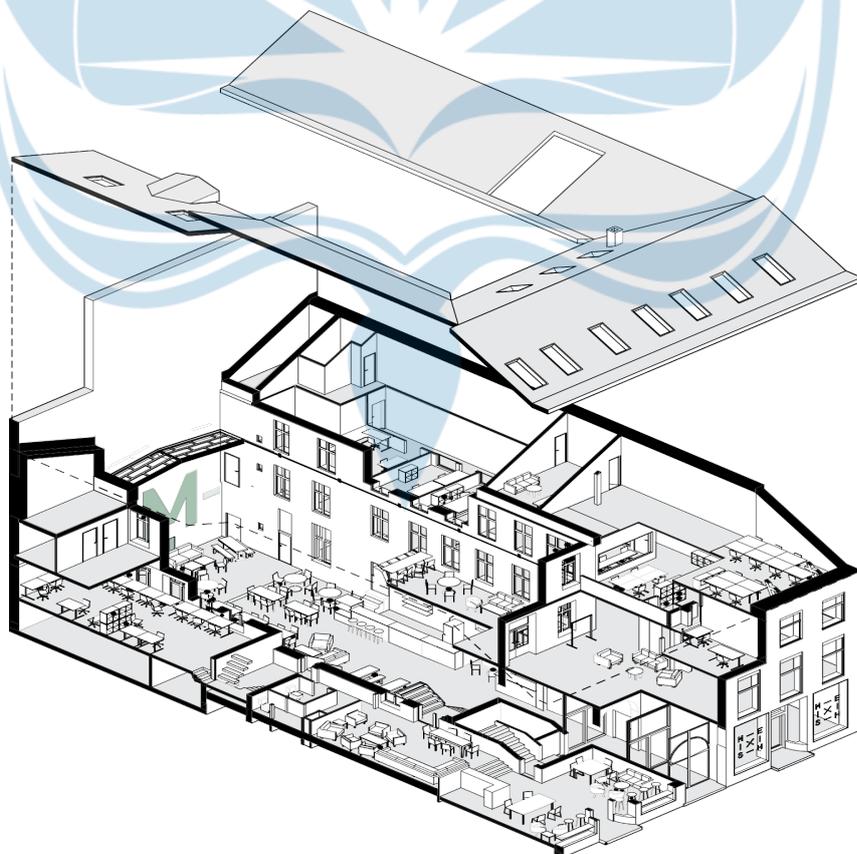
Denah Lantai 3 MESH Gate 3, Norwegia.
